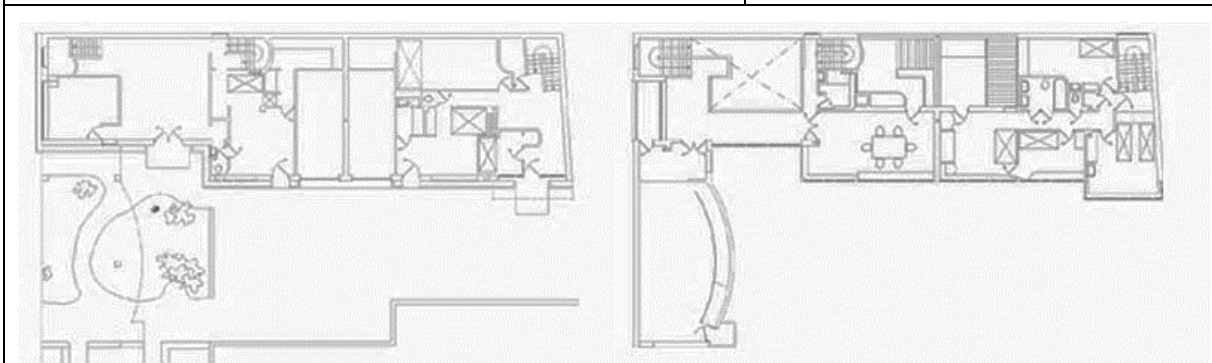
Grundriss des EG (links) und 1.OG (rechts)* [27]
